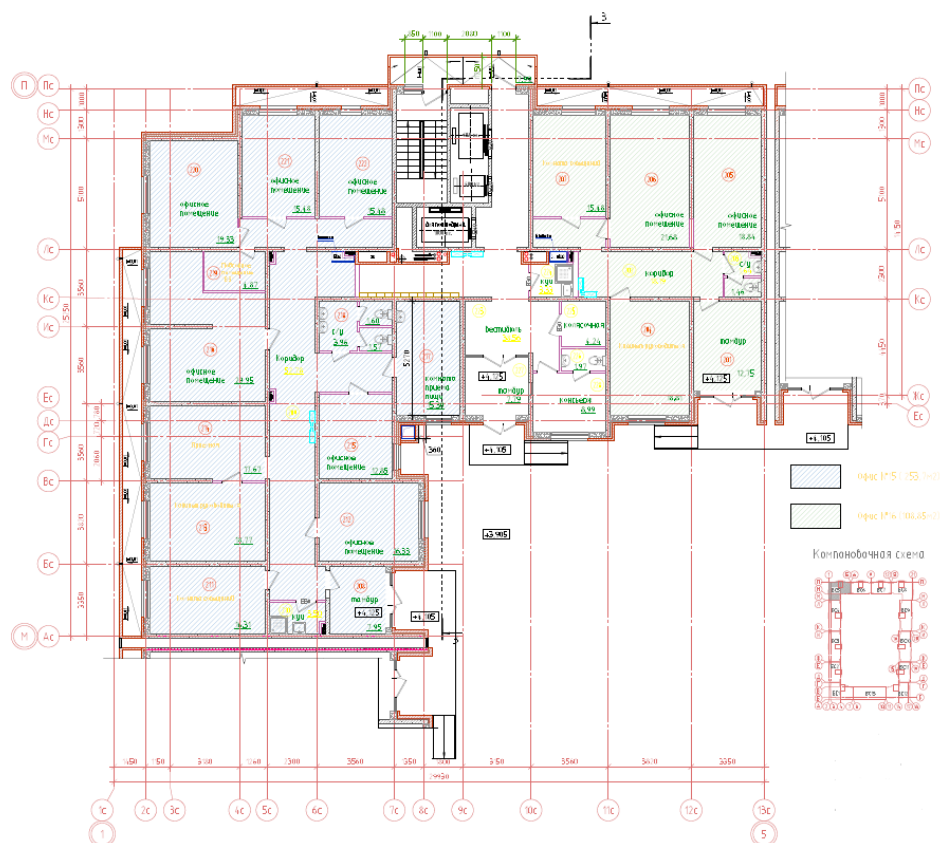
План 2 этажа БС-5 ЖК URAL
